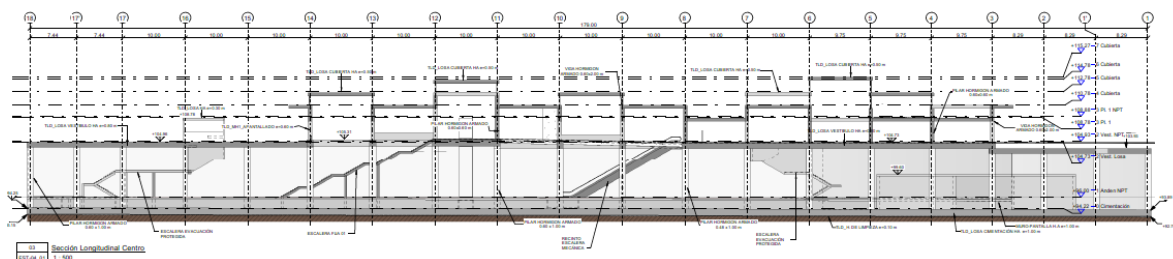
Alzado-sección longitudinal de la estación (fuente: PC estación de Telde)
